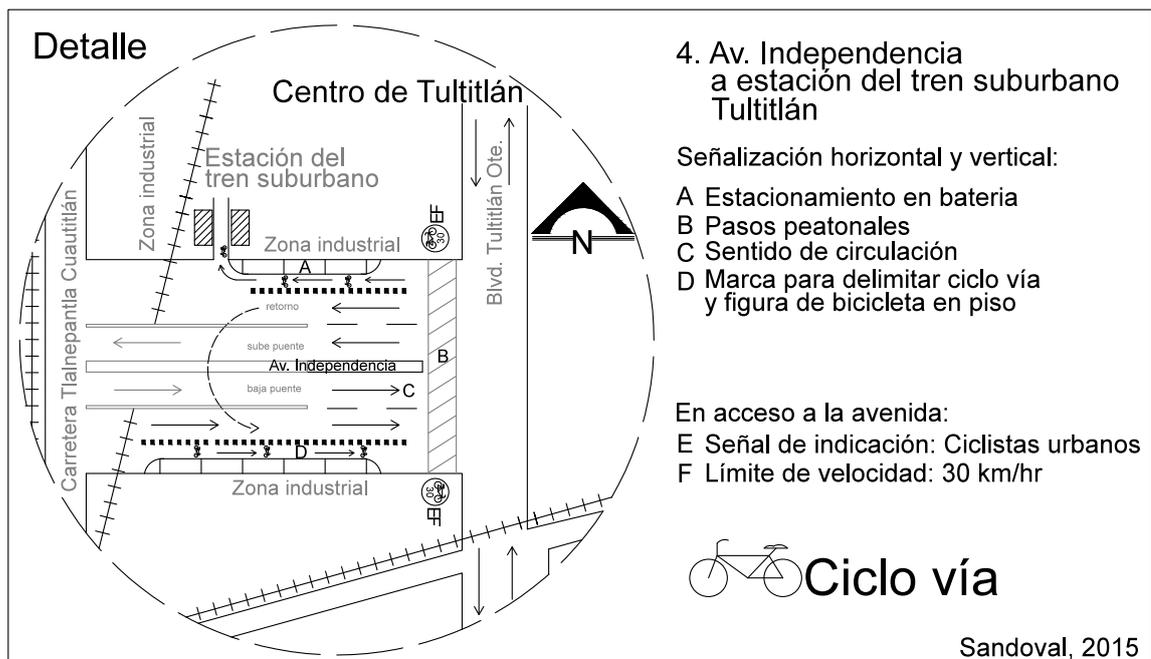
Detalle de acceso a la Av. Independencia. Fuente: La autora.
